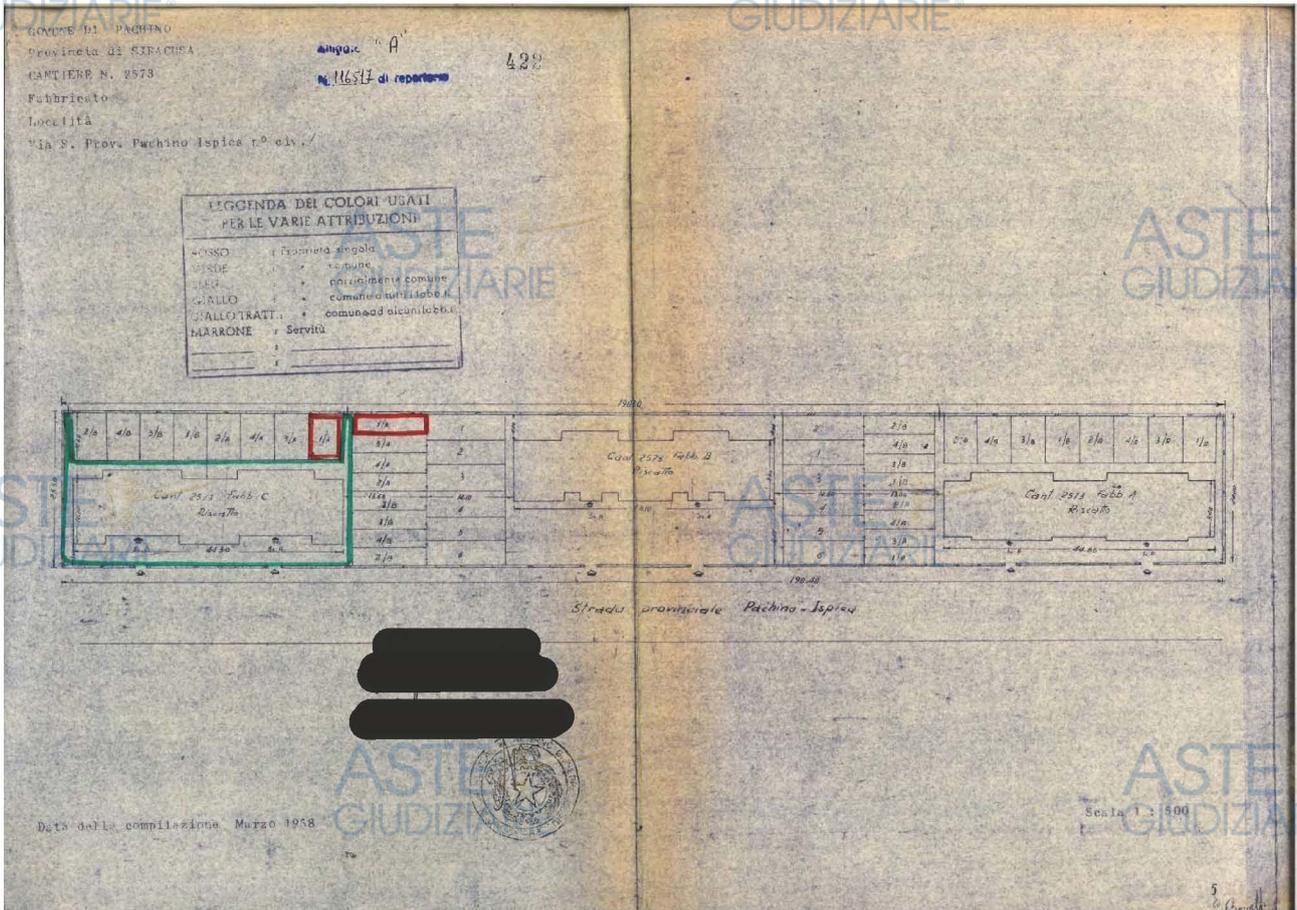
Elaborato planimetrico allegato all’atto di compravendita del 25/10/1969 relativo al complesso condominiale
